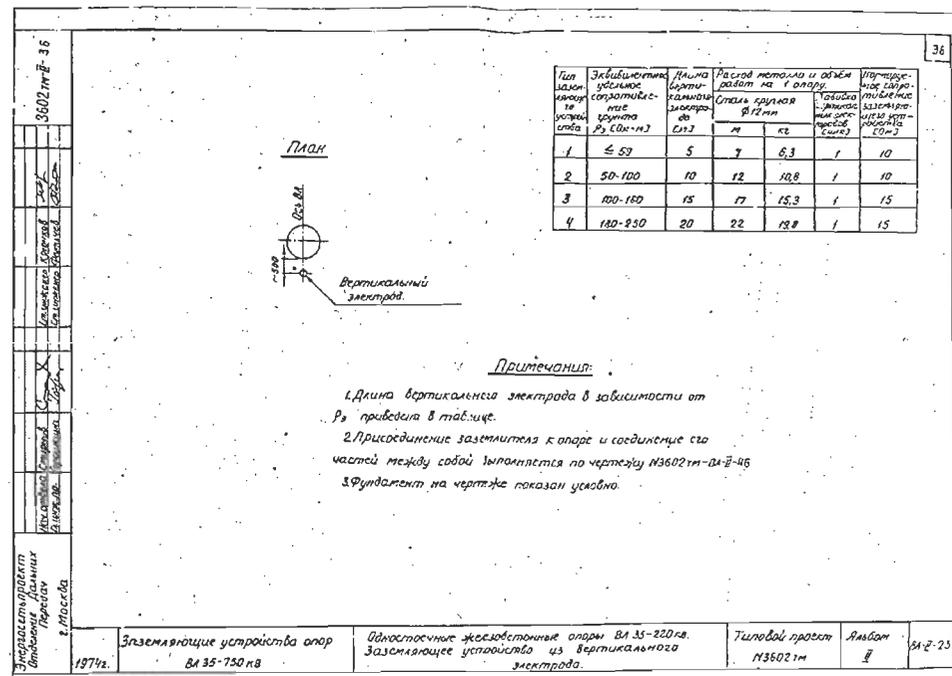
Схема установки заземлителя (чертеж № 3602тм-ВЛ-И-23).
